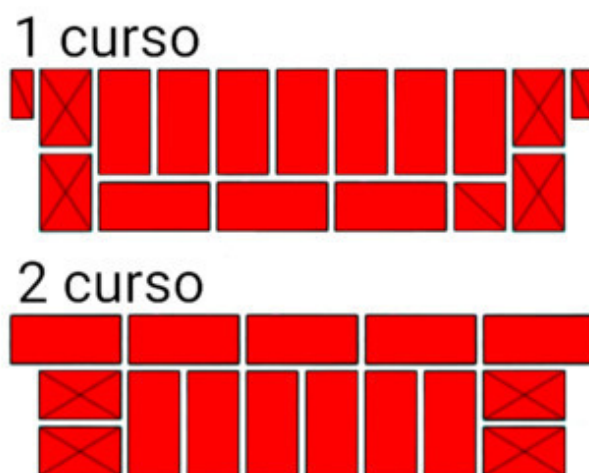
A ordem de colocar tijolos em uma seção de paredes entre as aberturas das janelas. Espessura da parede 1,5 tijolos.
